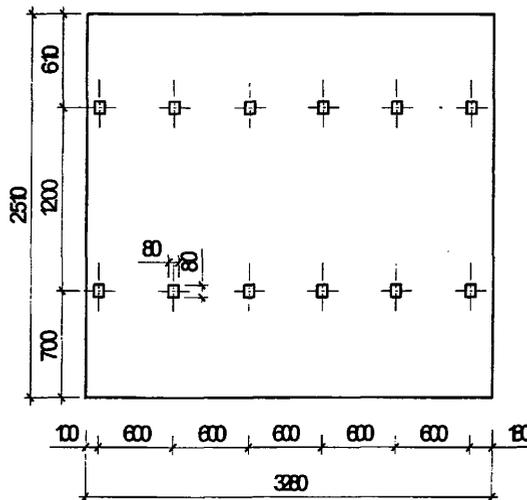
Схема наружной стены с указанием расчетной области
